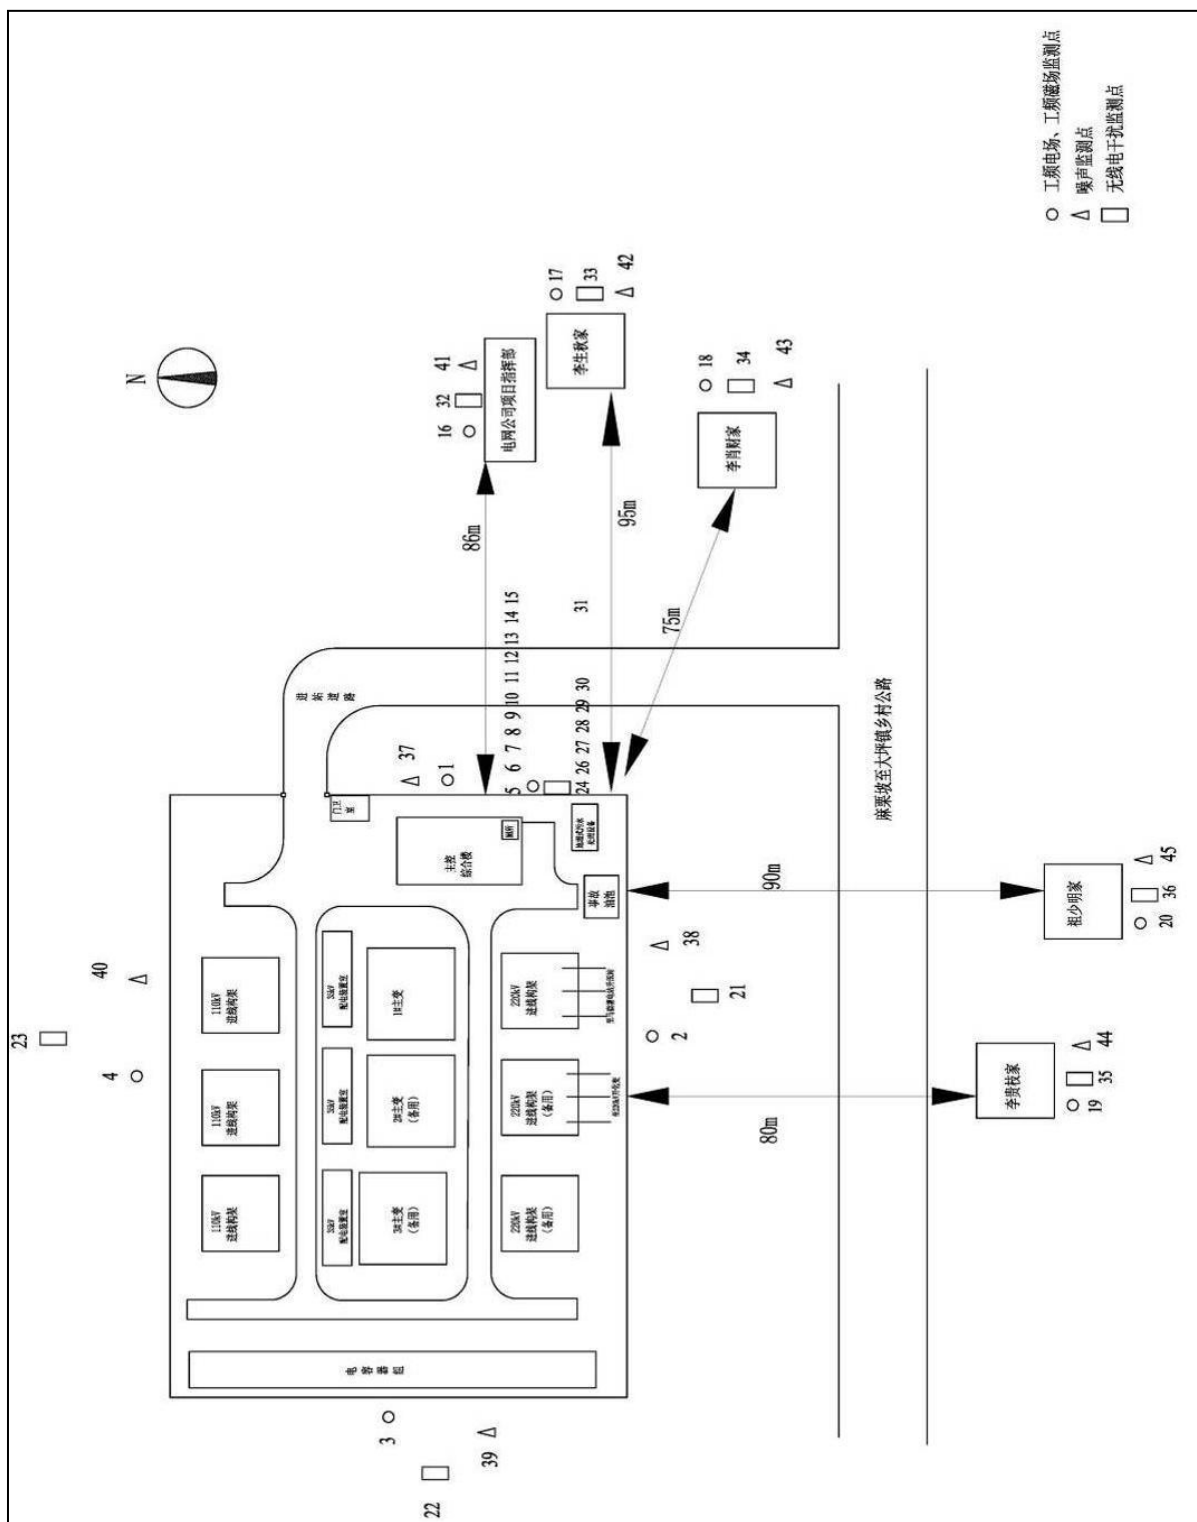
类比 220kV 老山变电站站区总平面布置及监测点布置图
